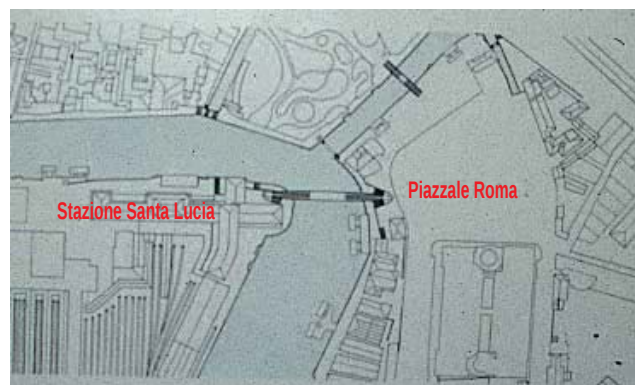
Vista in pianta del Ponte di Calatrava lungo 91 metri
